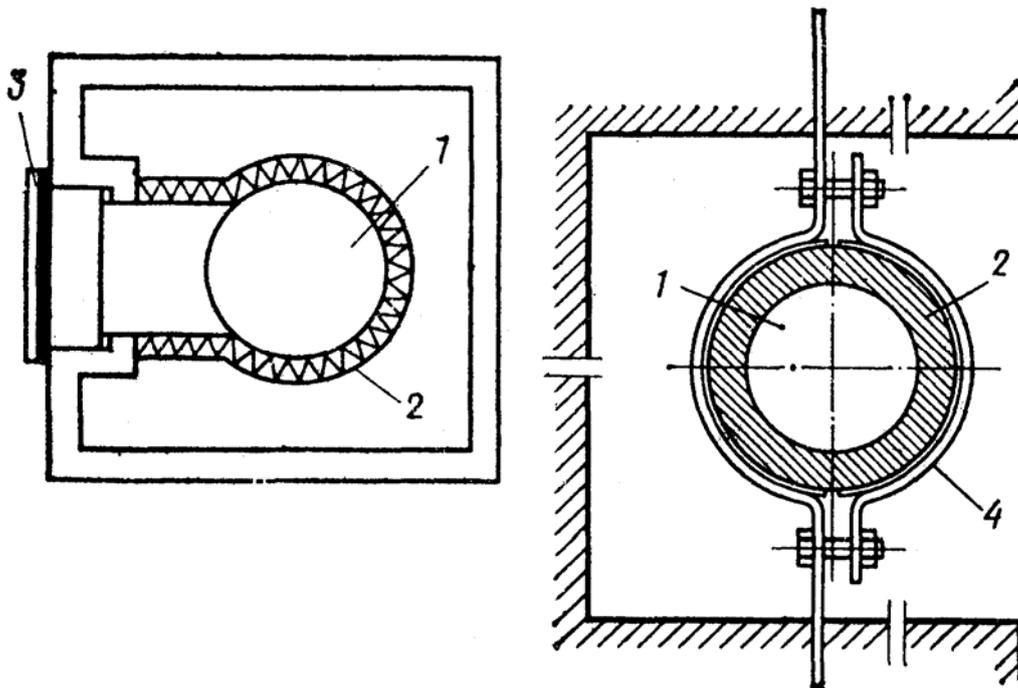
Схема звукоизоляции мусоропровода в жилом здании
